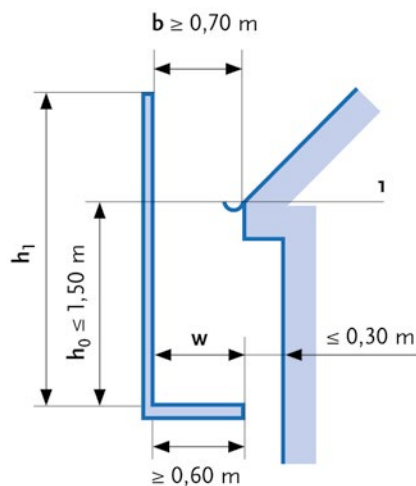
Bauliche Ausbildung der Dachfanggerüste nach DIN 4420-1
